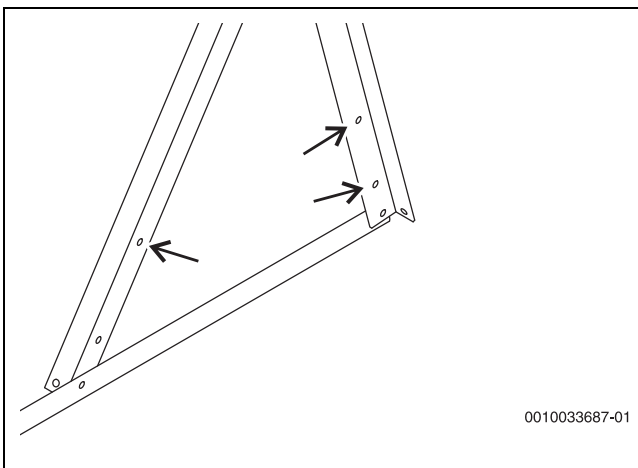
Exemplos de instalação do cabo de ligação à terra ao suporte de montagem
